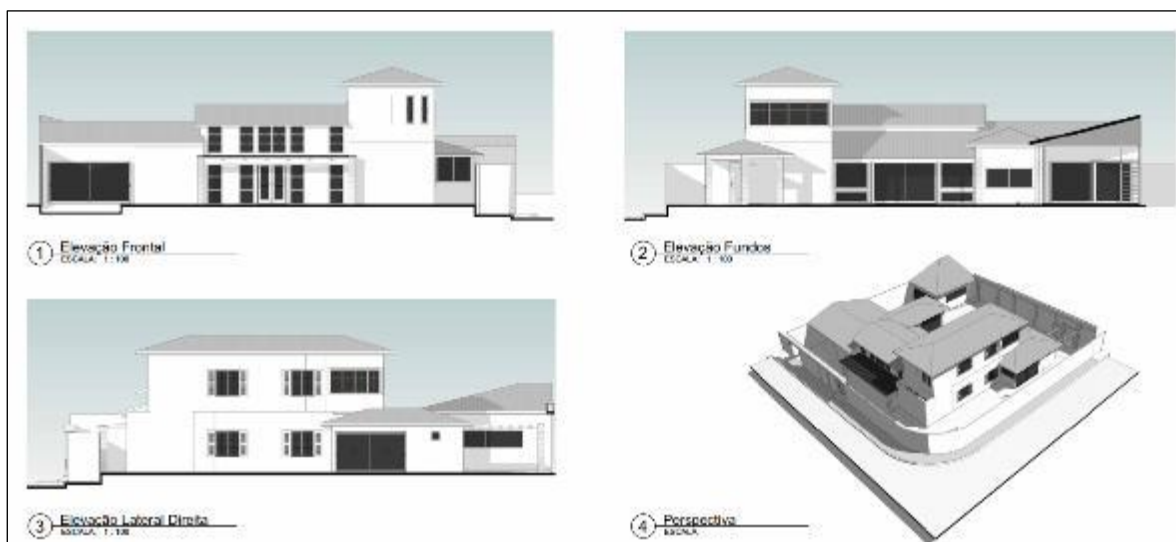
Vistas do Projeto de Arquitetônico da construção atual.
